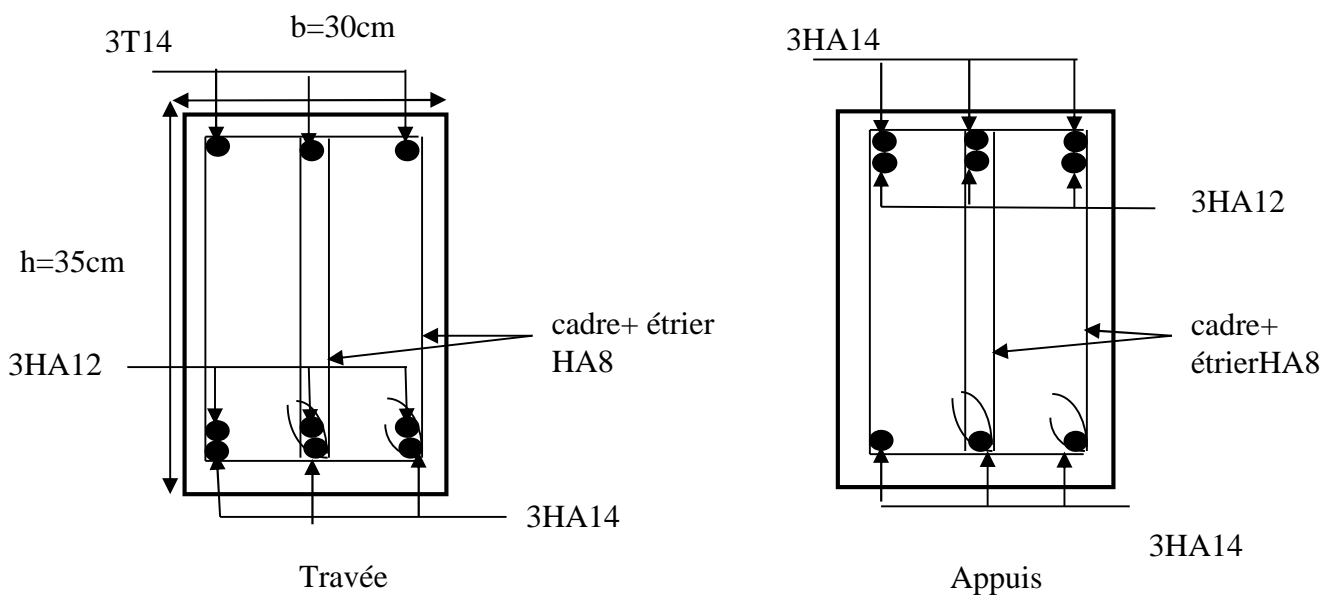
schémas de ferrailage des poutres secondaires de RDC+ l'étage
